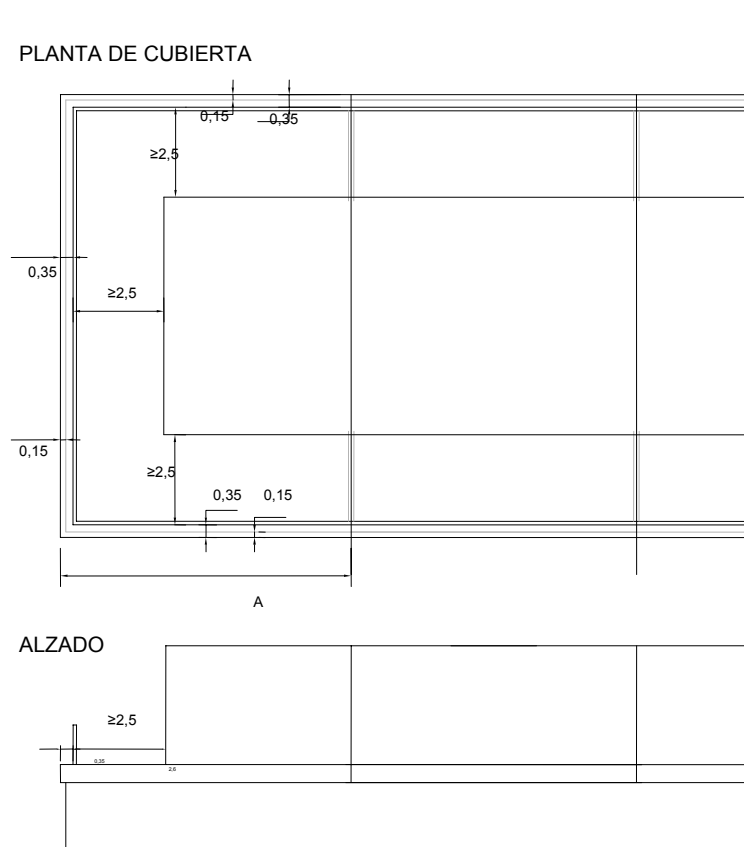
Formación de Cubierta-Terraza, planta-alzado
